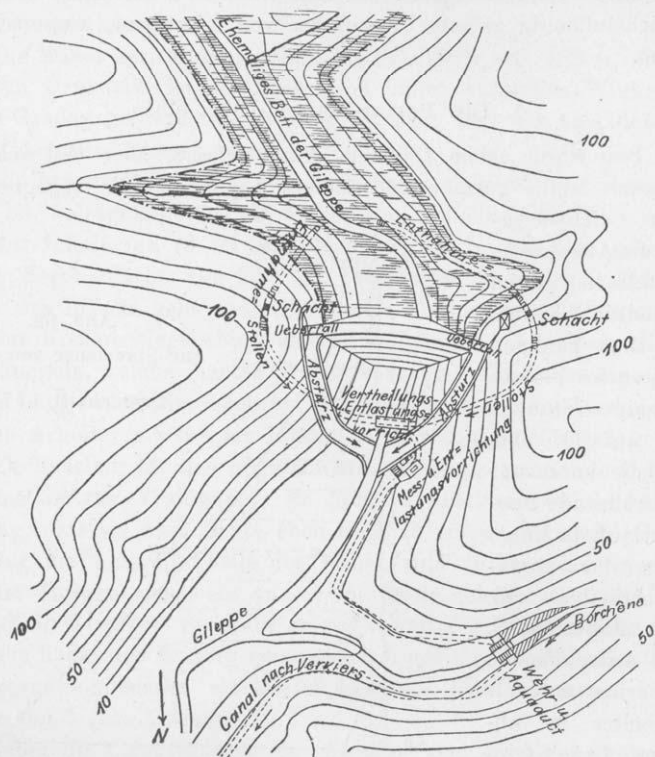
Die Staumauer der Gileppe. Lageplan.
